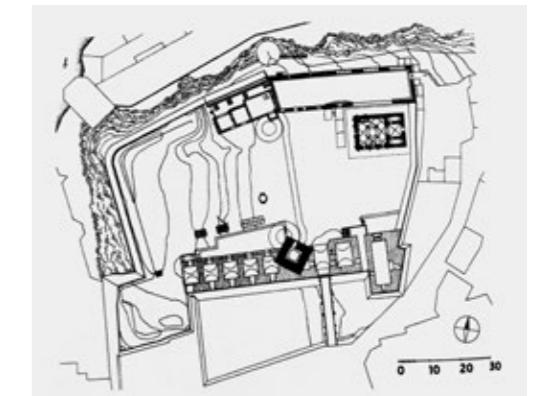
Eger (Cheb), Grundriss der Burganlage
